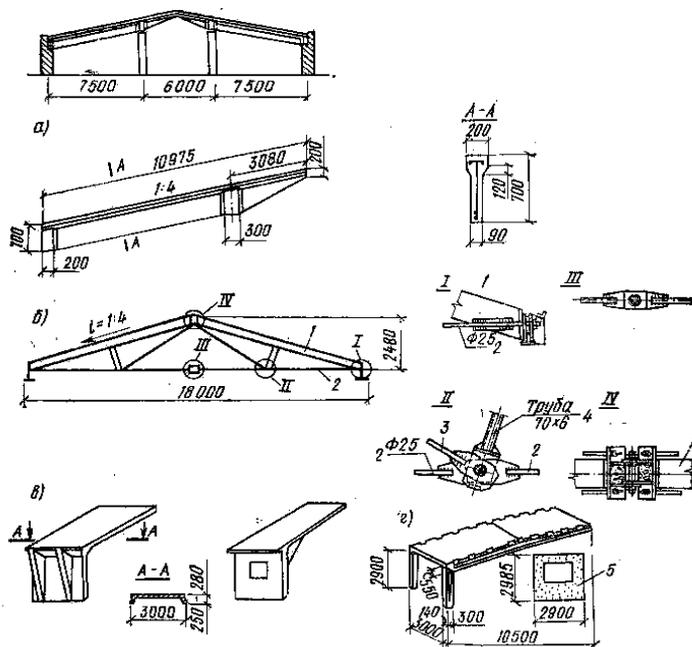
Сборные железобетонные несущие конструкции:
